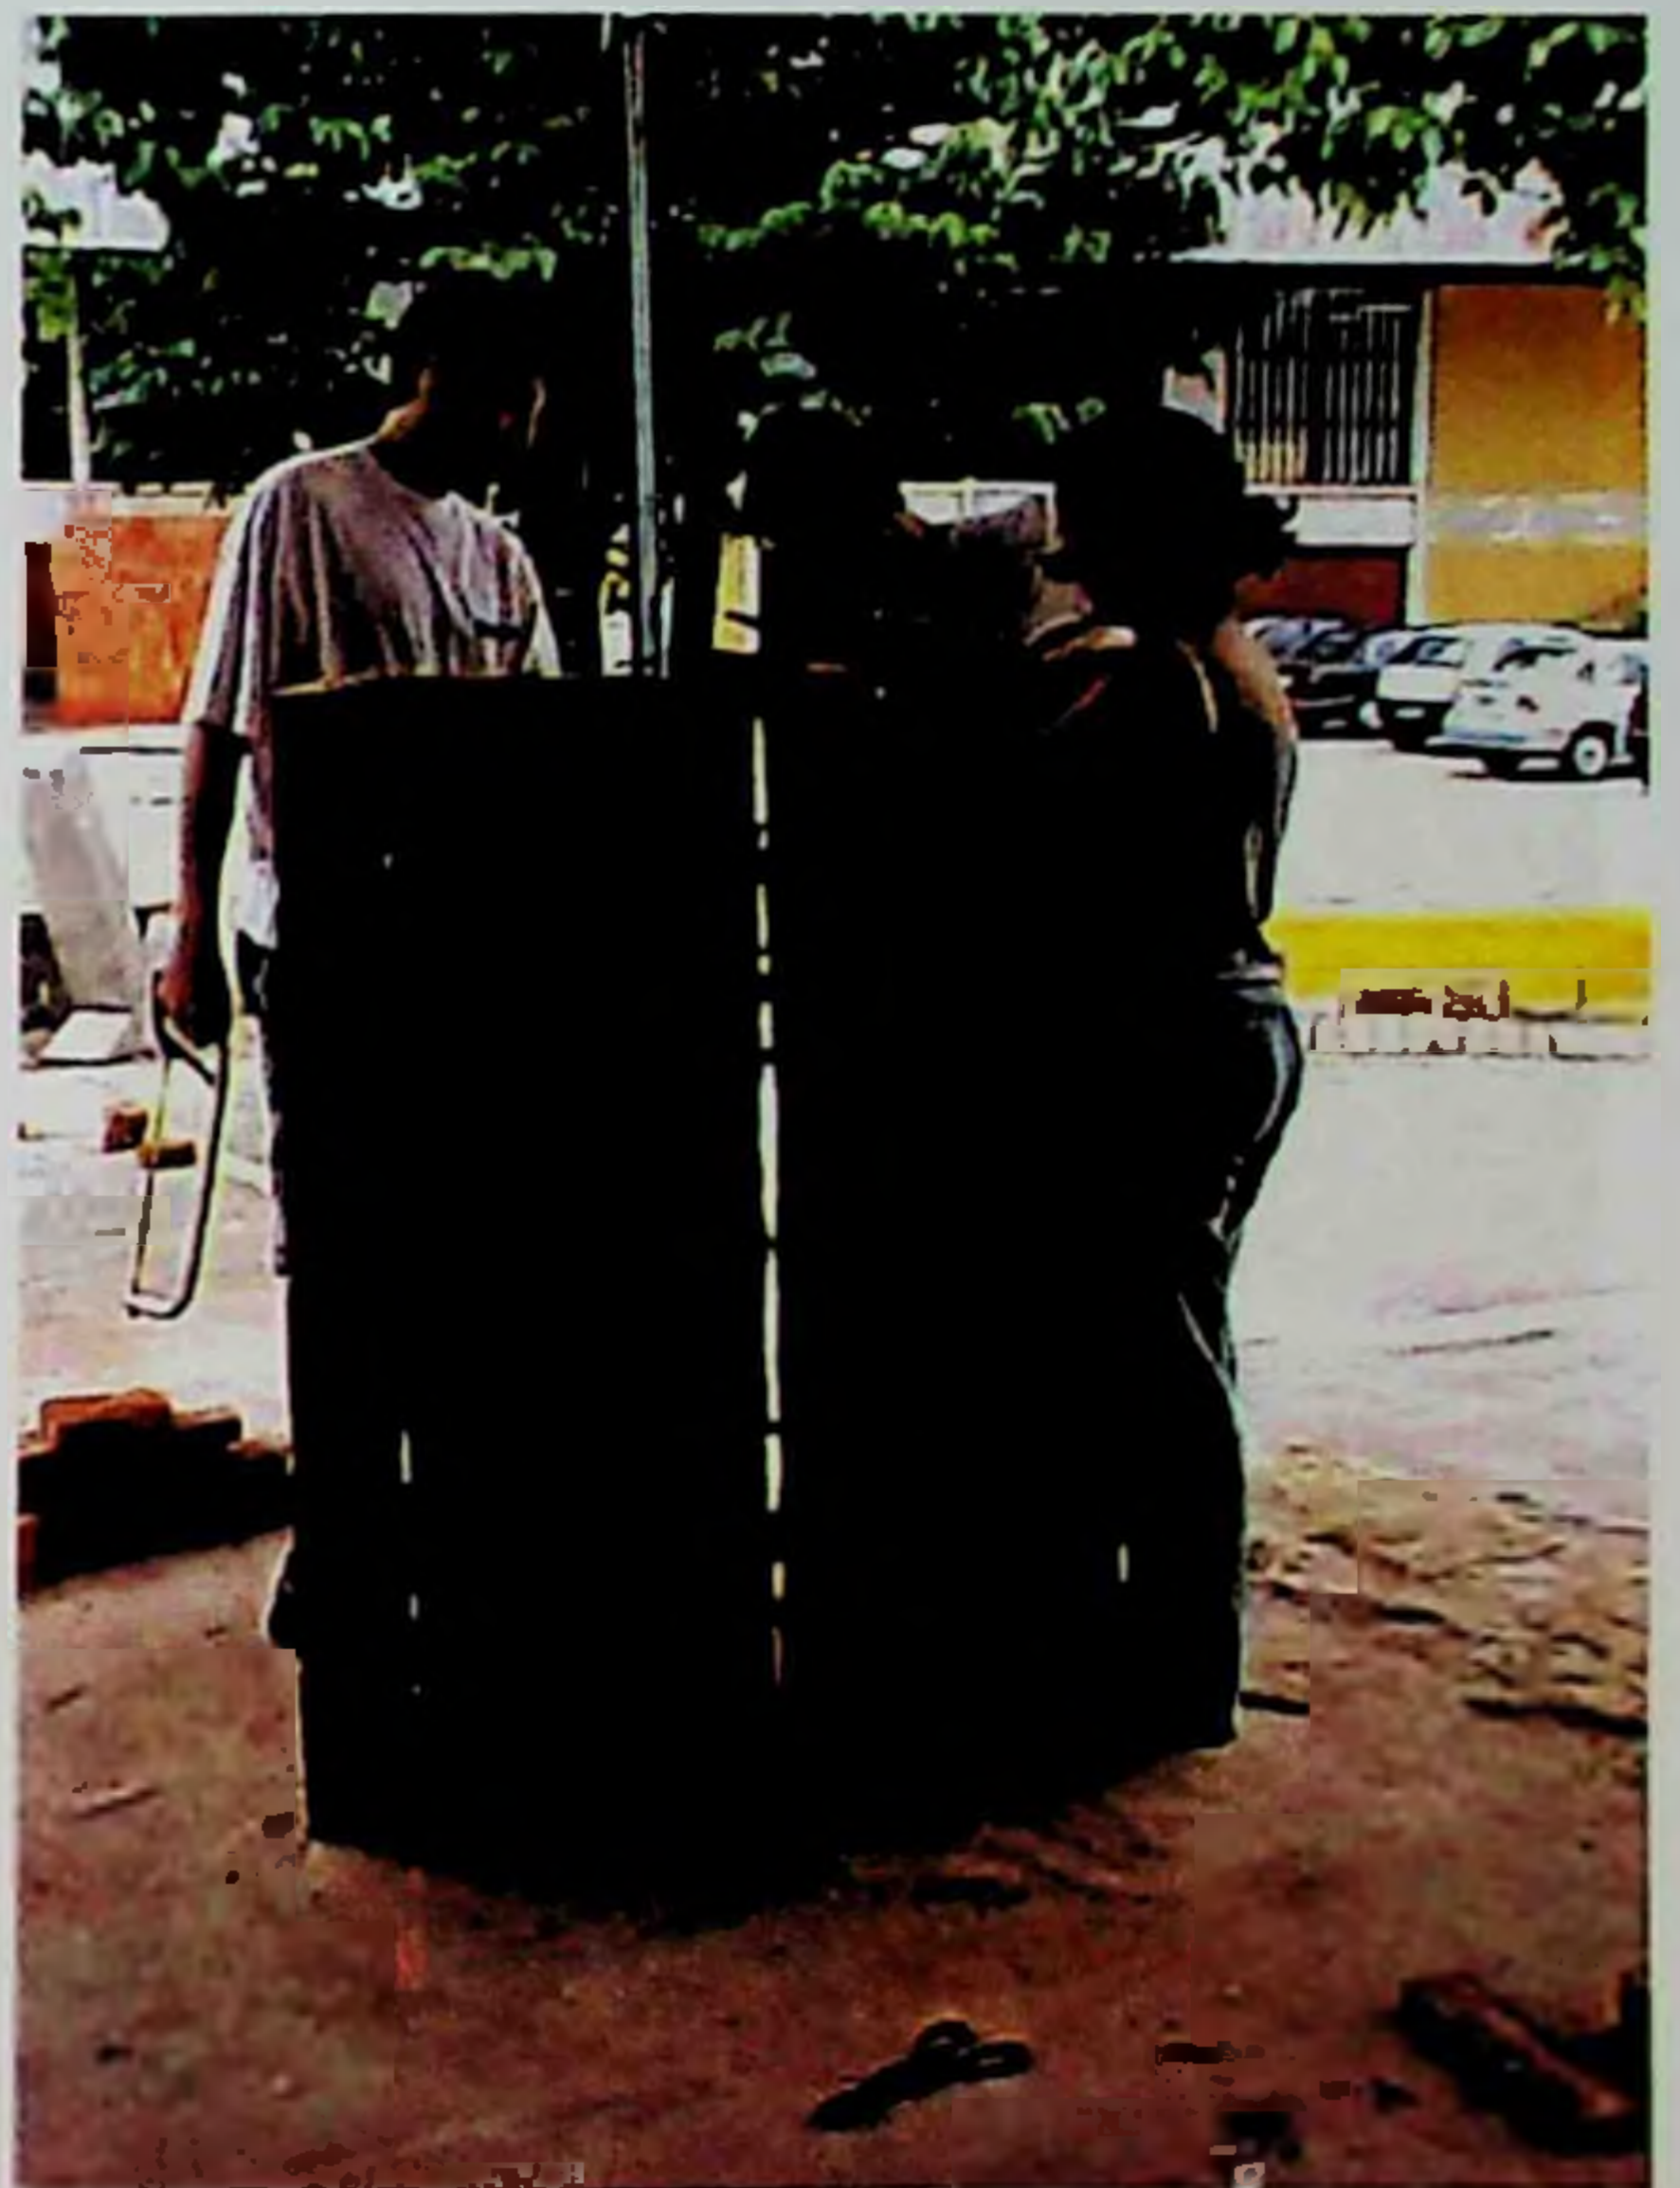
Preparação da forma para execução dos painéis "Beno: de tijolos.
